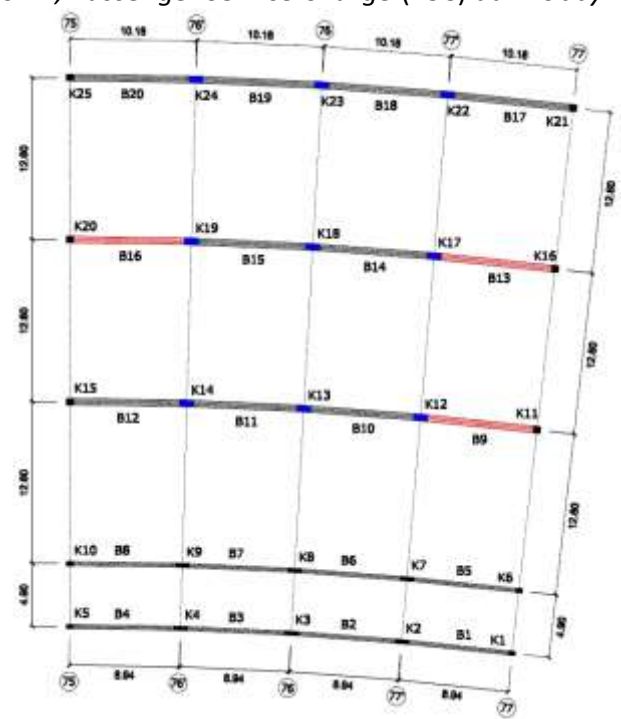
Lokasi Balok dan Kolom Terminal 1A Anjungan 3 Lantai 1 (Area : Breakdown)
